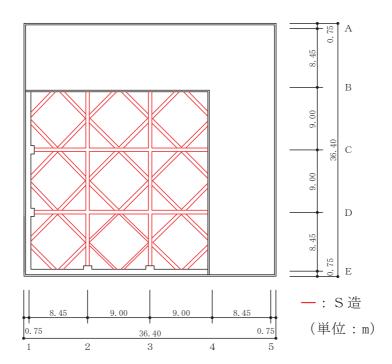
(5) 緊急時対策建屋の概略平面図 (0.P.75.9m)
